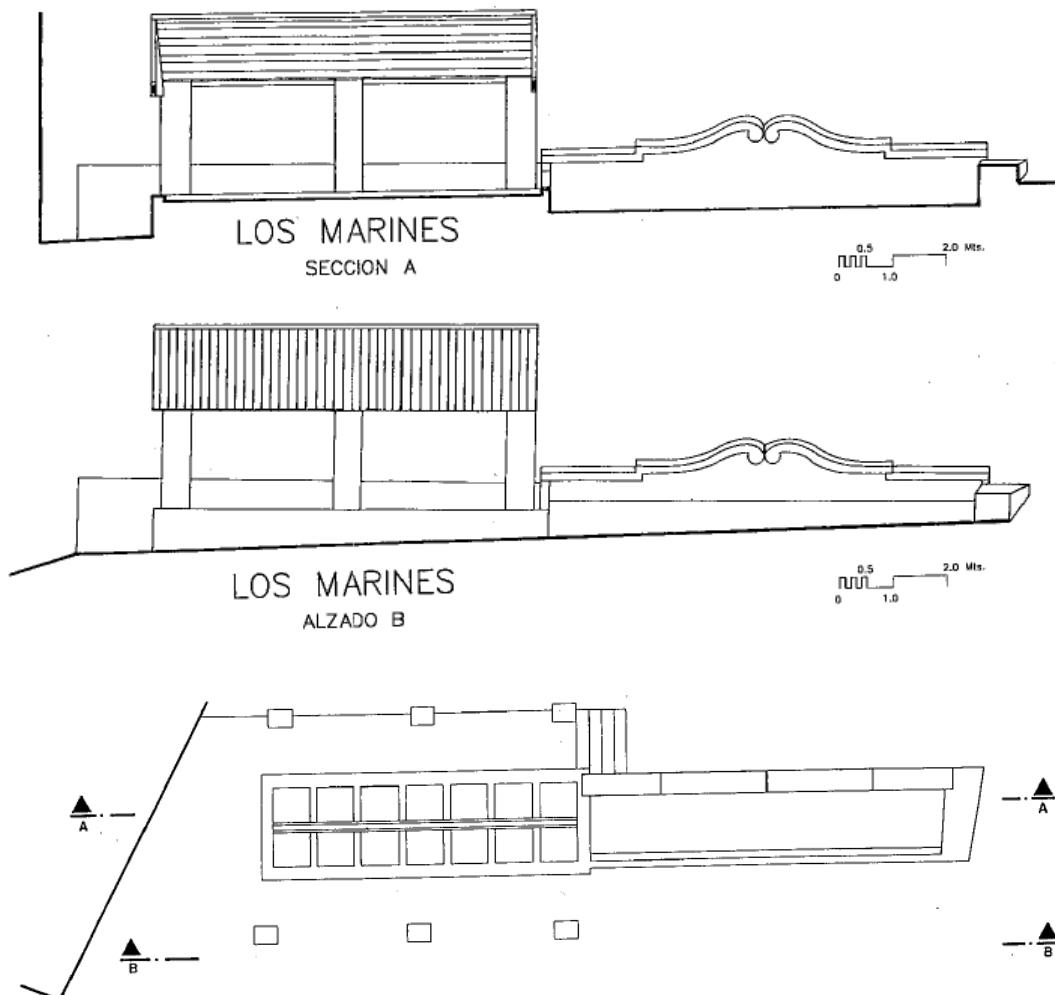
Planta general, sección y alzado del lavadero de Los Marines (Medianero, 2003)
